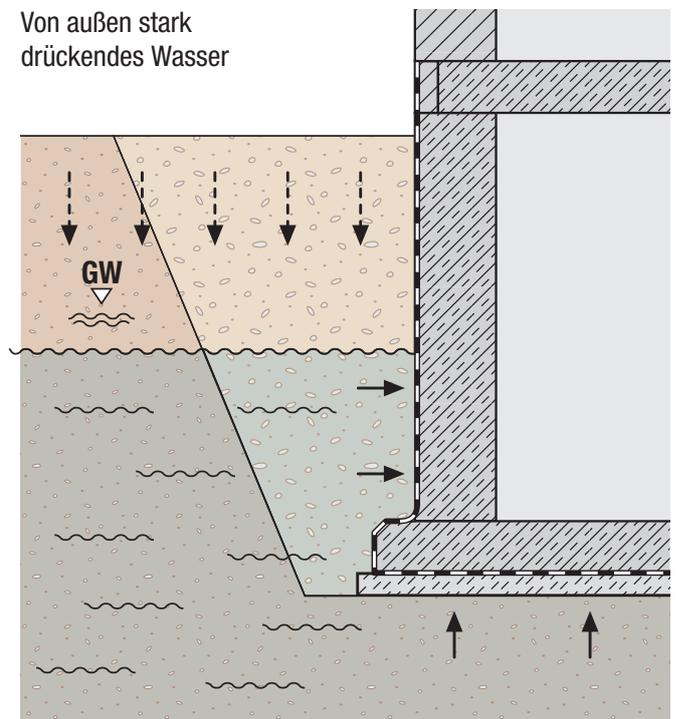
Wasserbeanspruchung erdberührter Bauwerke nach DIN 18 195-6
